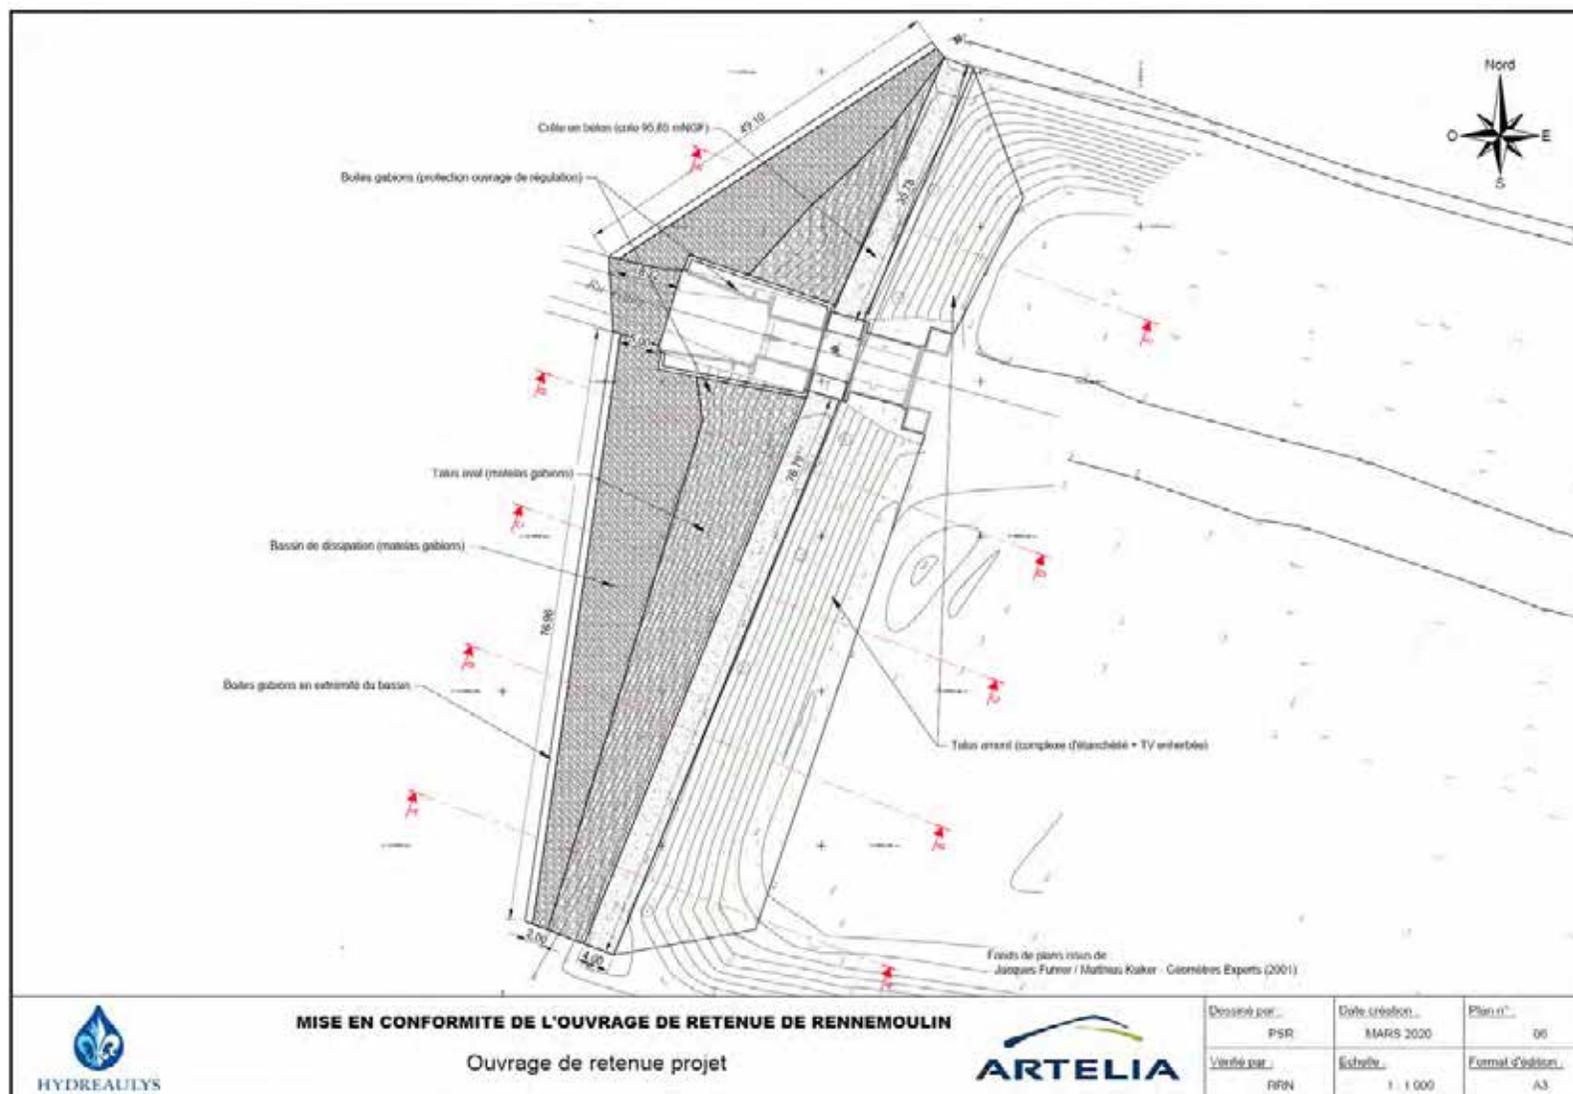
Vue en plan de l'ouvrage de retenue en l'état projet
